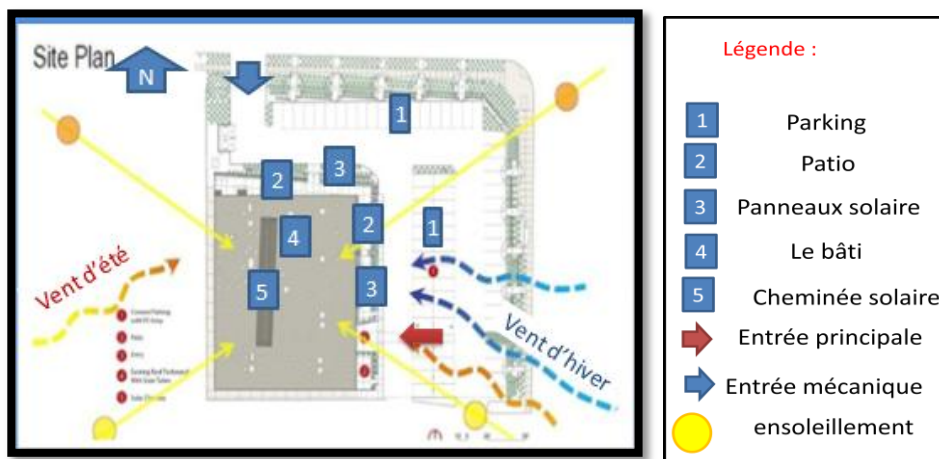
Plan de masse du projet (source : <http://living-future.org>)
